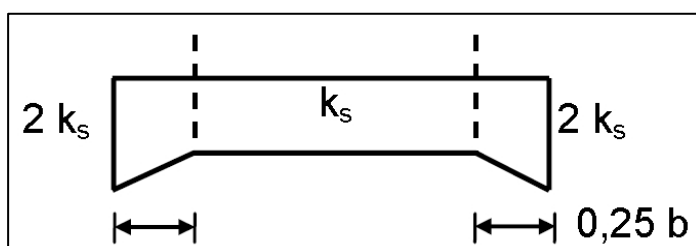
Bettungsmodulverteilung nach DÖRKEN und DEHNE
